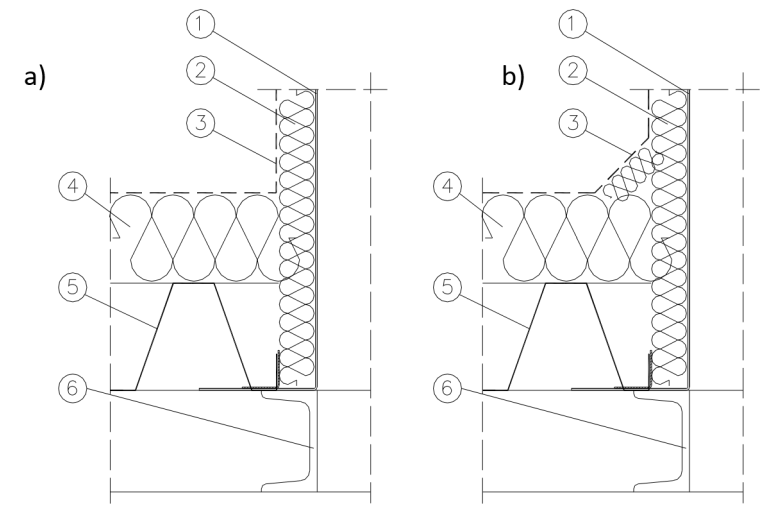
Стальное основание на стальной конструкции (а – обработка мембраной, б – обработка рубероидом)
